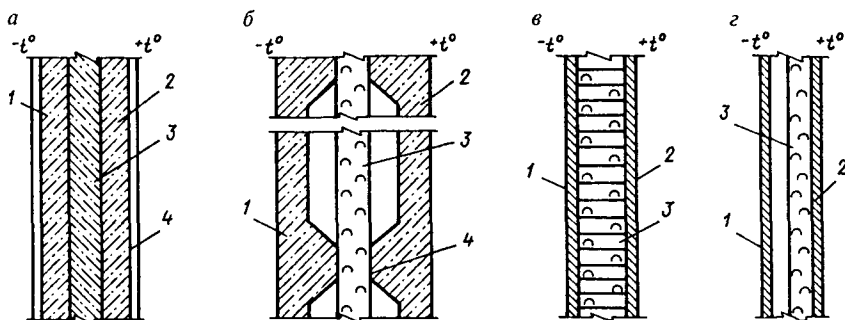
Схемы трехслойных панелей наружных стен с обшивкой
